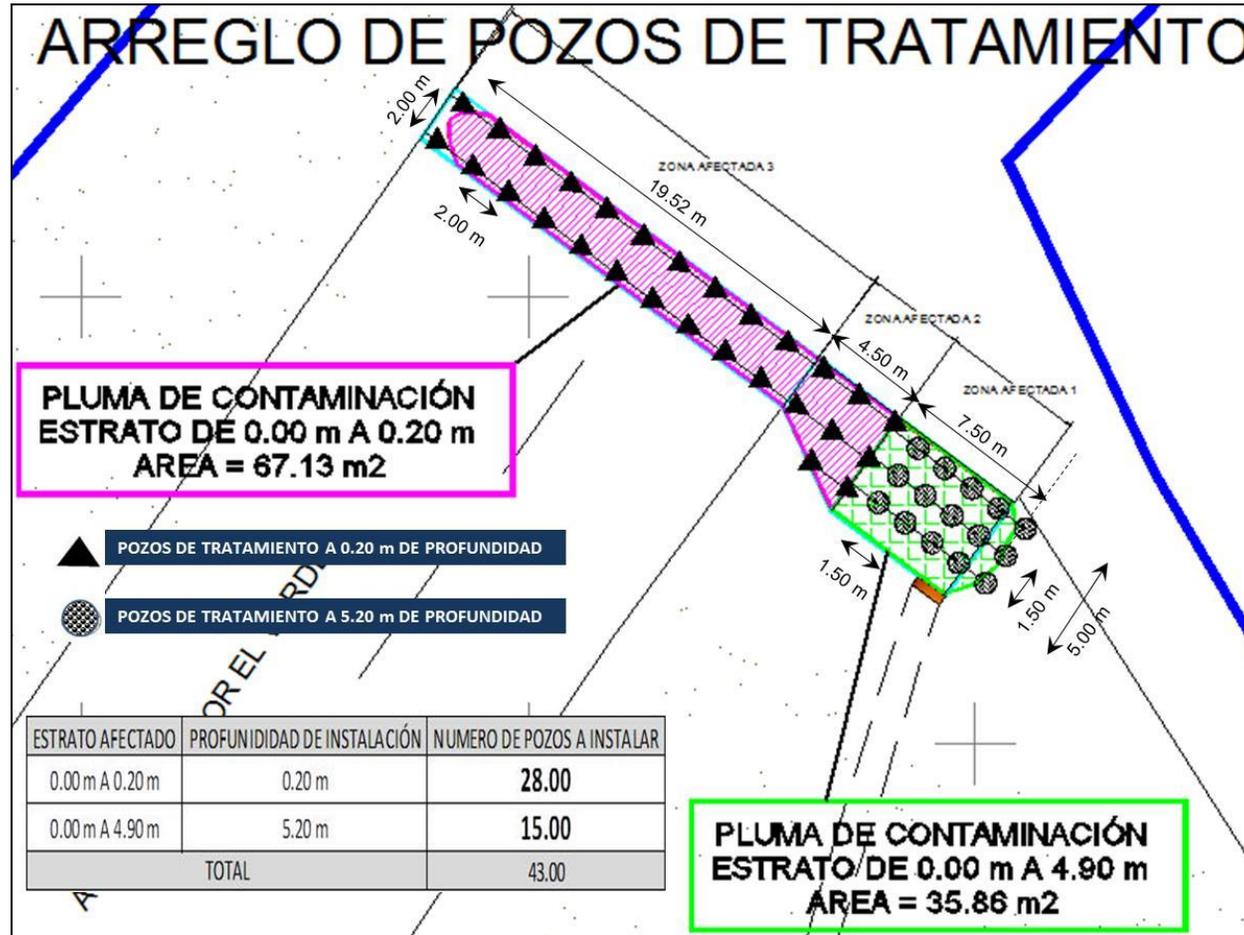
Distribución de los pozos en las Zonas Afectadas 1, 2, y 3 para la restauración de suelo contaminado con HFL.
